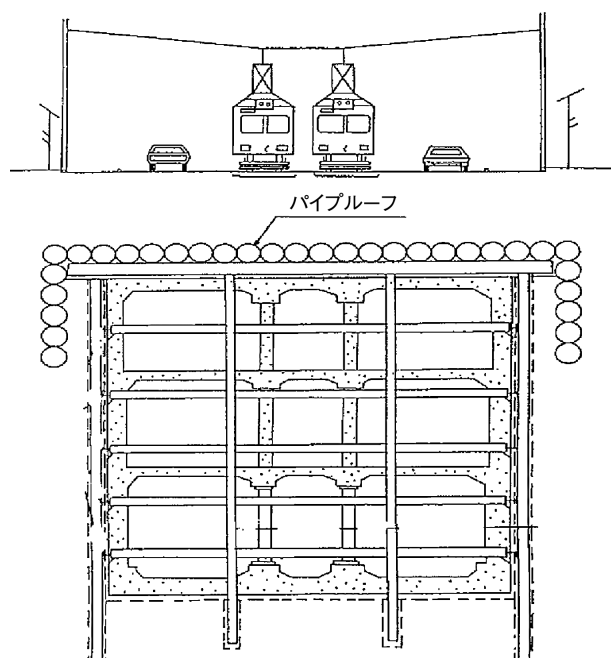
国内初の泥水式推進工法によるパイプルーフ断面図³⁾
